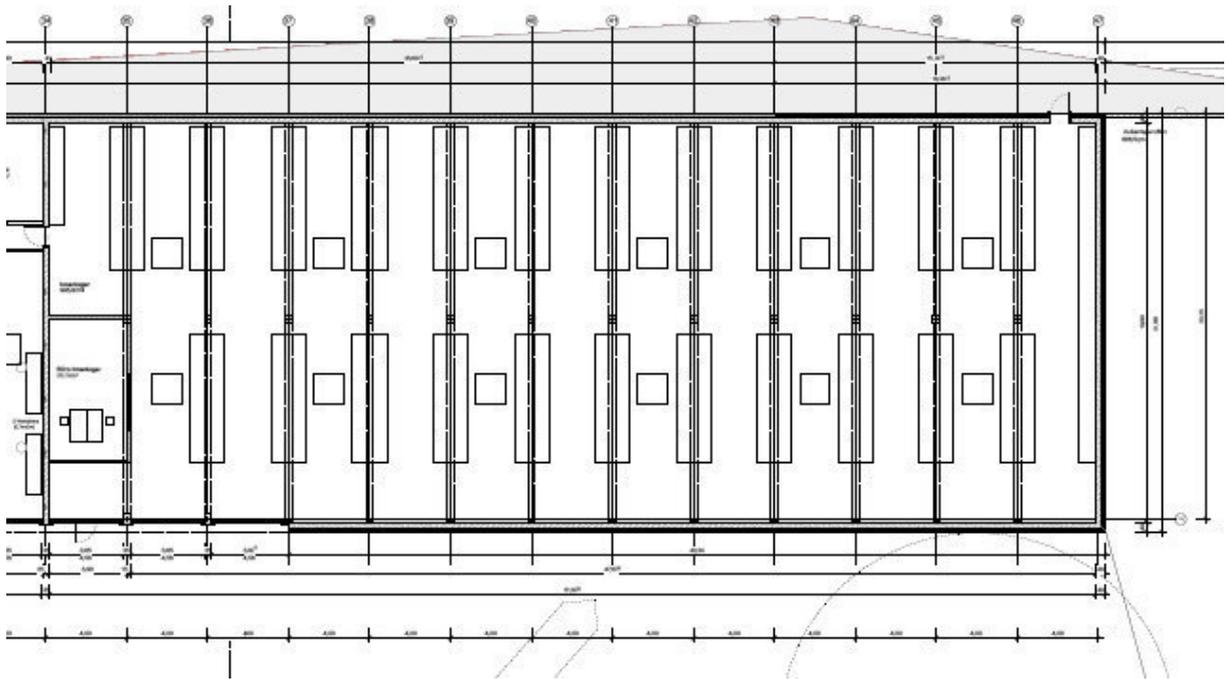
B3 Grundriss Erdgeschoss
